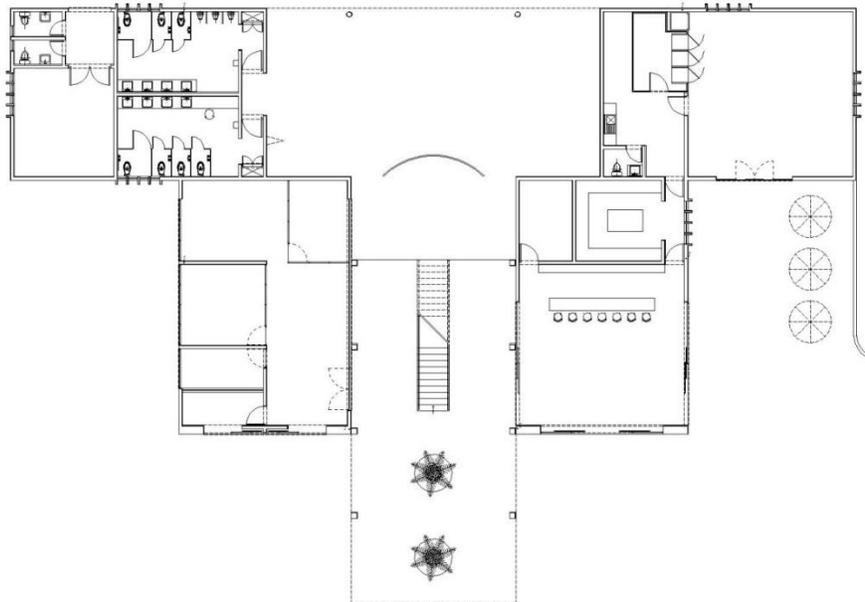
31. Planta Arquitectónica Alta tipo de la Casa Club Palapa.
